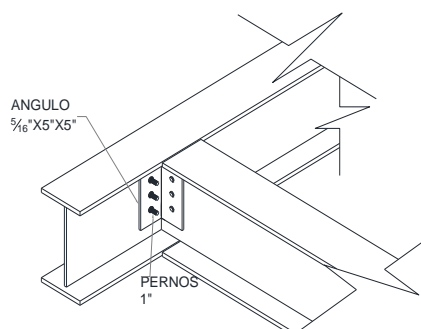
Configuración típica de conexión viga-vigueta con pernos.
